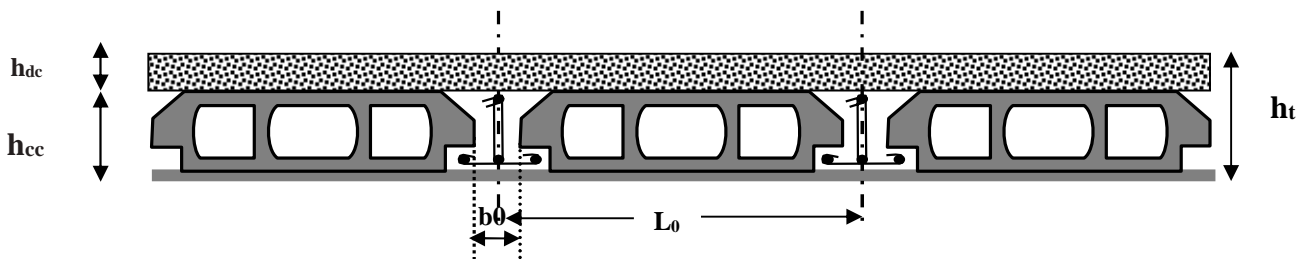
Coupe transversale sur un plancher à corps creux.
